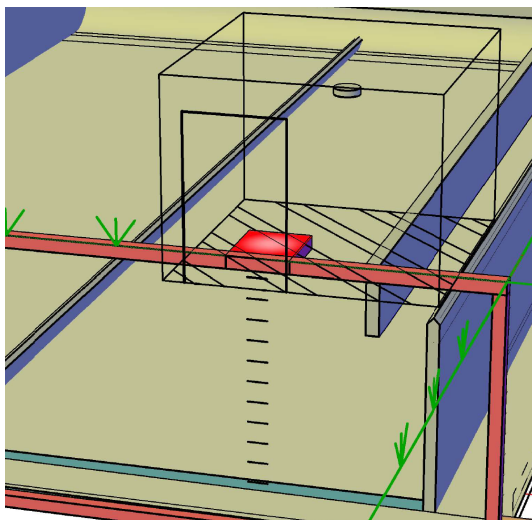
Detalle de trampilla de acceso y pates de bajada extraído del Plano de Alzado.
